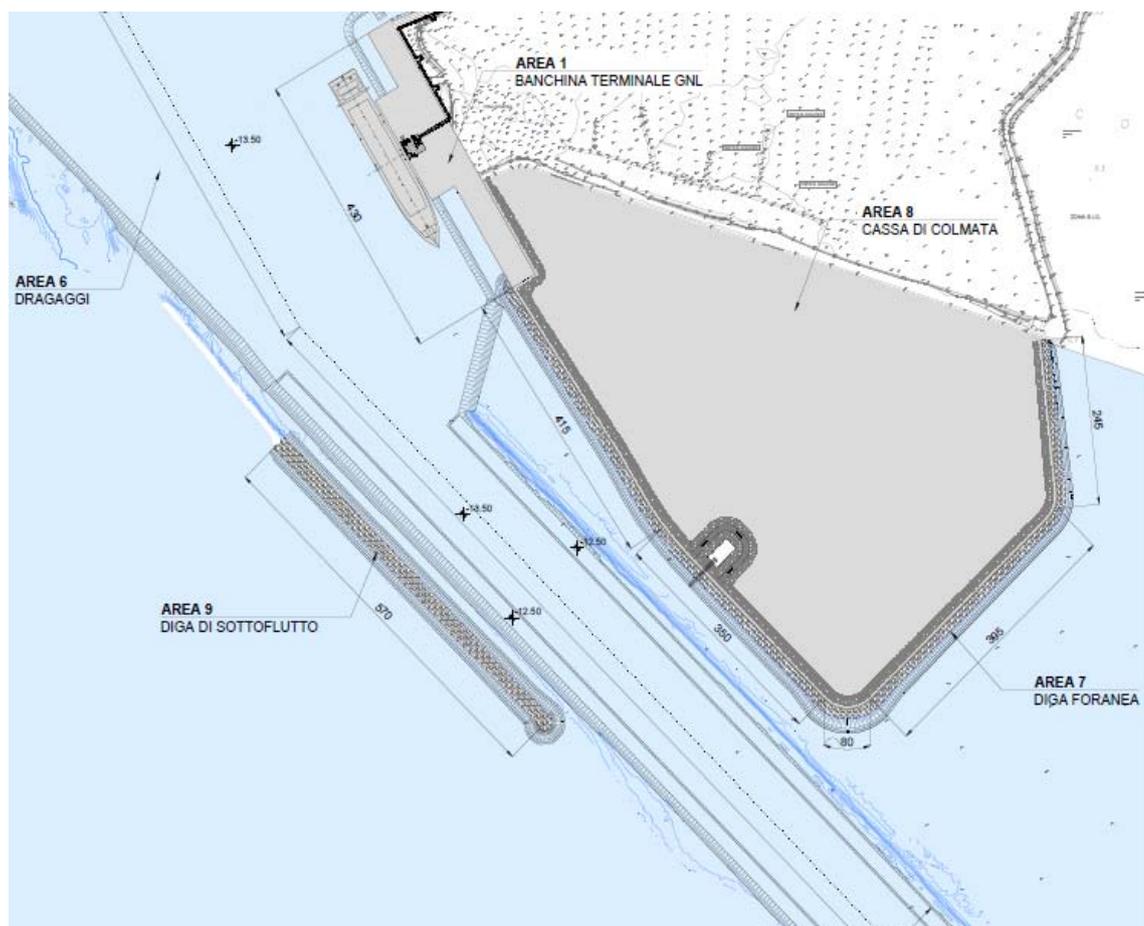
Planimetria con Individuazione Aree di Progetto – Opere a Mare
